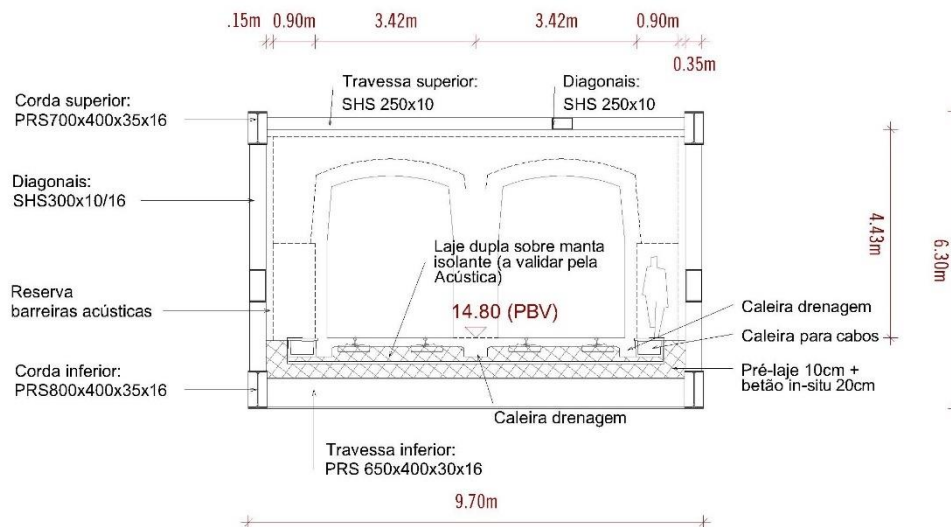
Corte construtivo Viaduto (ML 134364).
